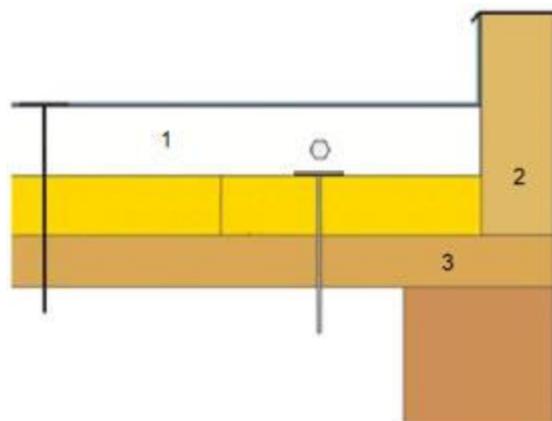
Exemple du traitement sur rive avec l'élément porteur reposant sur un appui transversal continu
